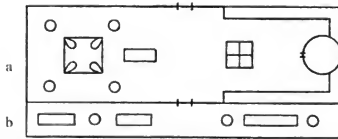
Brauhaus auf dem Grundrisse zu St. Gallen. (Gebäude links.)
